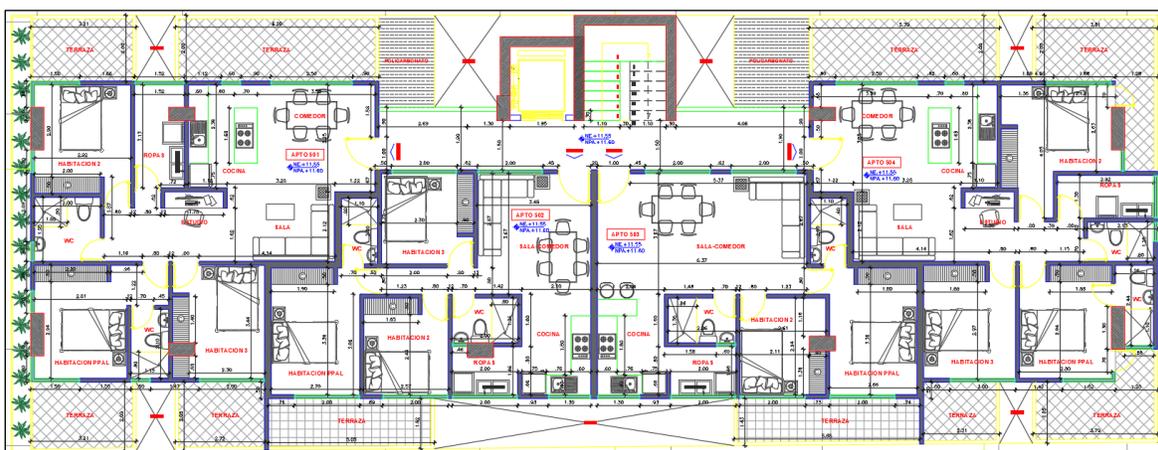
Planta arquitectónica piso 5 (fuente: Planos arquitectónicos Arq. Mario Huertas)
